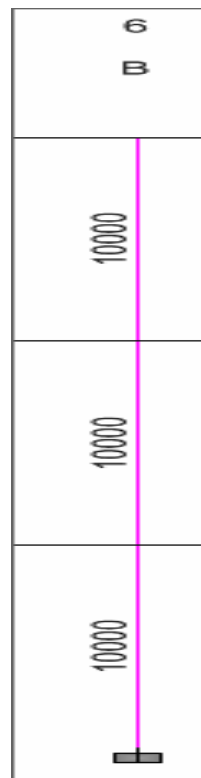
Concrete Frame Design Overwrites (UBC 97)
